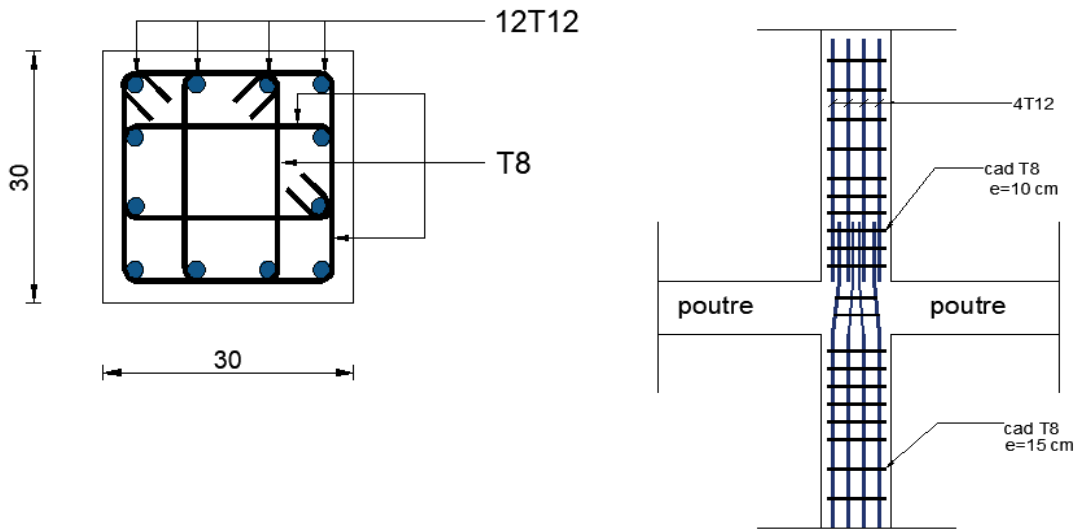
schéma de ferrailage des poteaux carrés de 8^{ème} et 9^{ème} étages
